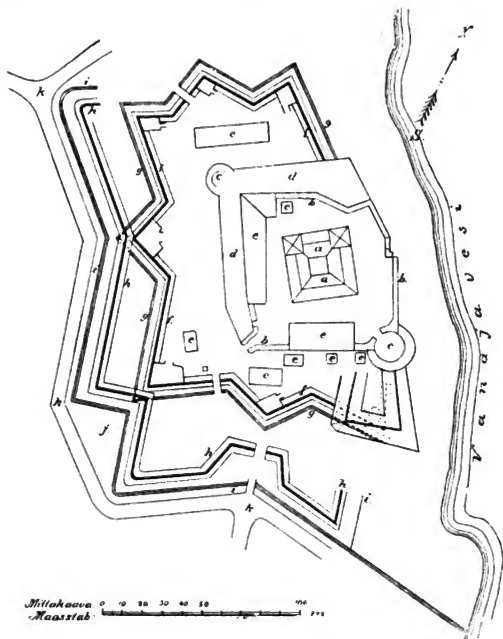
Plan der Burg und ihrer Aussenwerke 1759 (a-g) sowie der Wälle mit Gräben i. J. 1882 (h, i).
